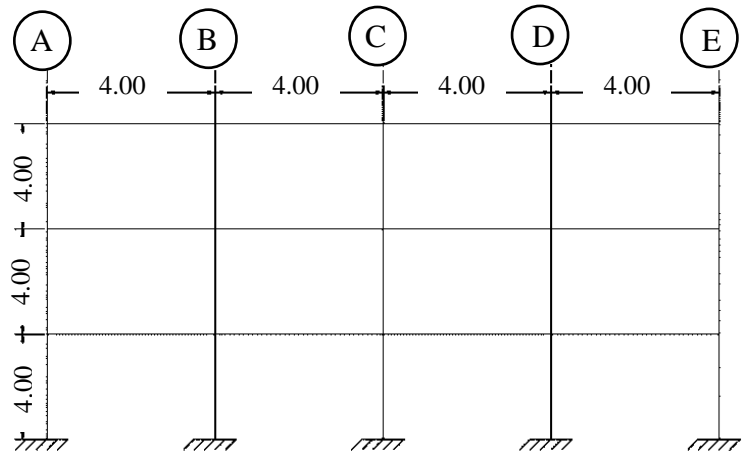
Esquema visto en elevación de la estructura unidad (m). Escala 1:250. Fuente Autores
